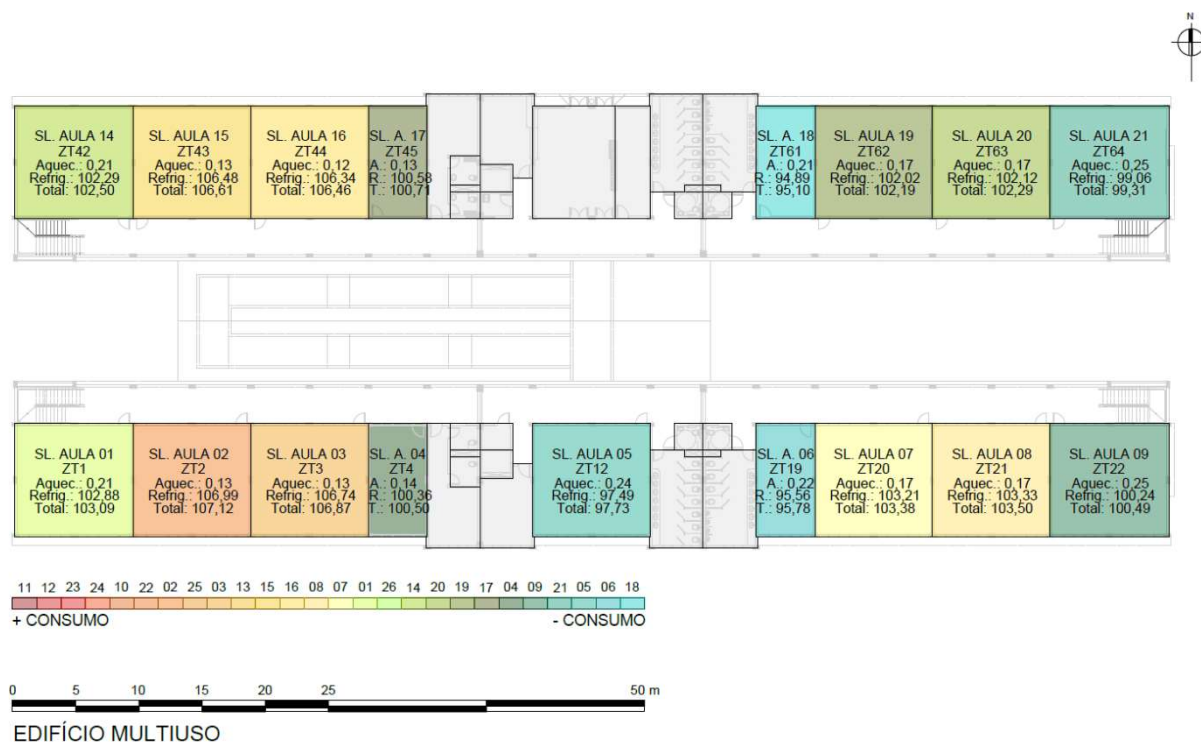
Integração de estratégias projetuais - Planta Baixa do Pavimento Superior com consumo para aquecimento, refrigeração e total por m²
